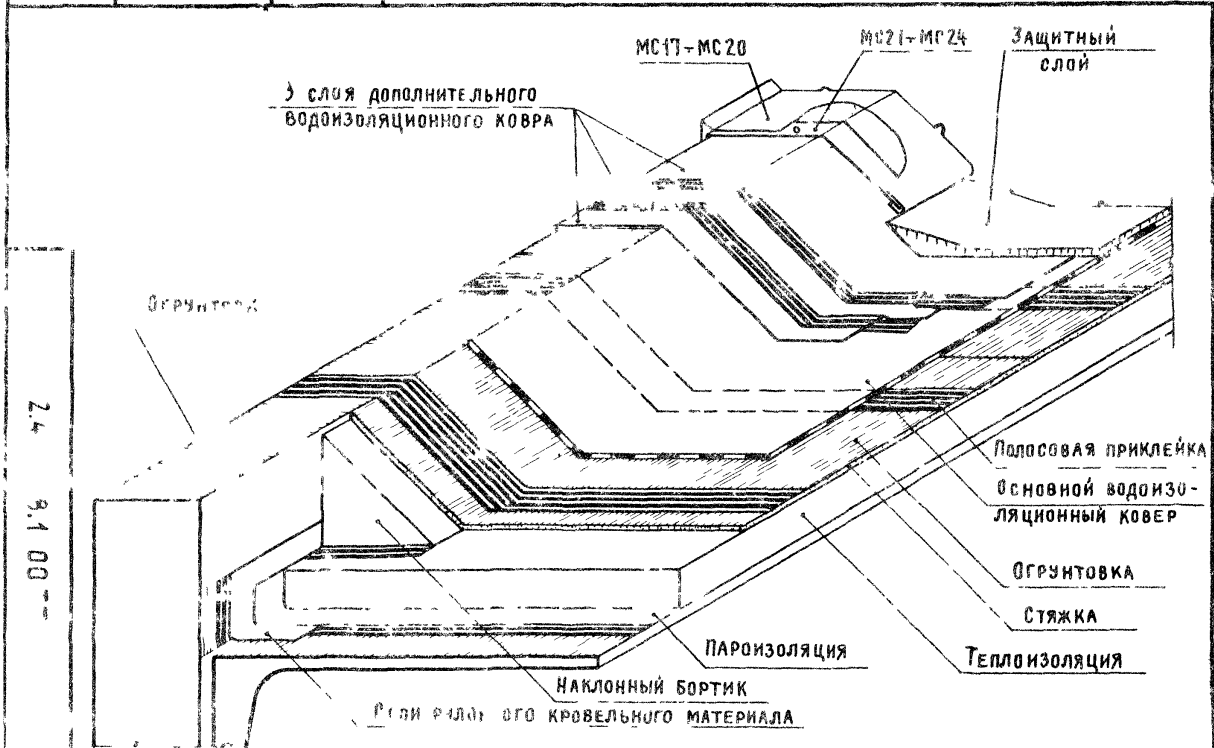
Паралет высотой до 200 мм продолжной стены при уклоне кровли до 2,5% (с выходом водяных паров)
